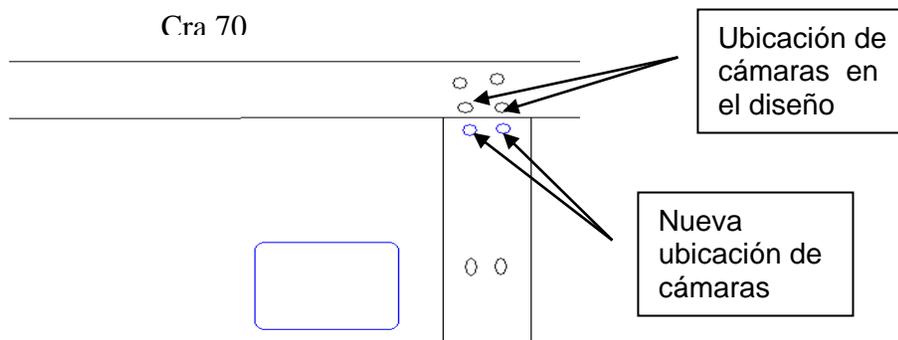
Esquema de ubicación de cámaras de inspección de alcantarillado.
